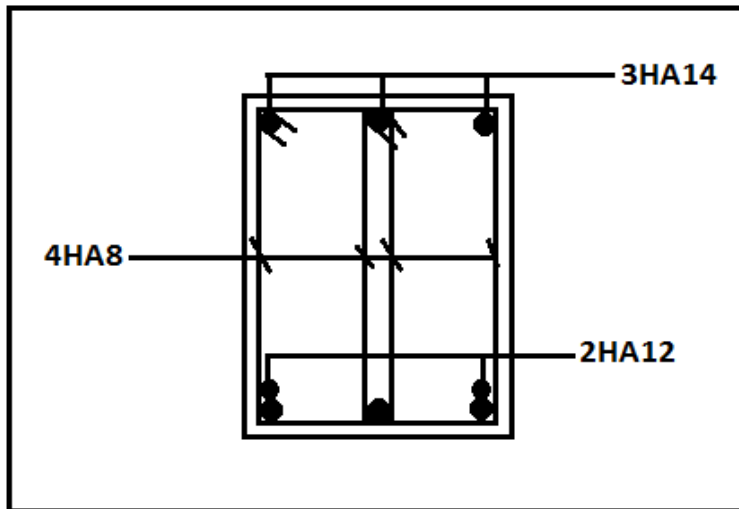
Ferrailage en travée d'une poutre secondaires .
